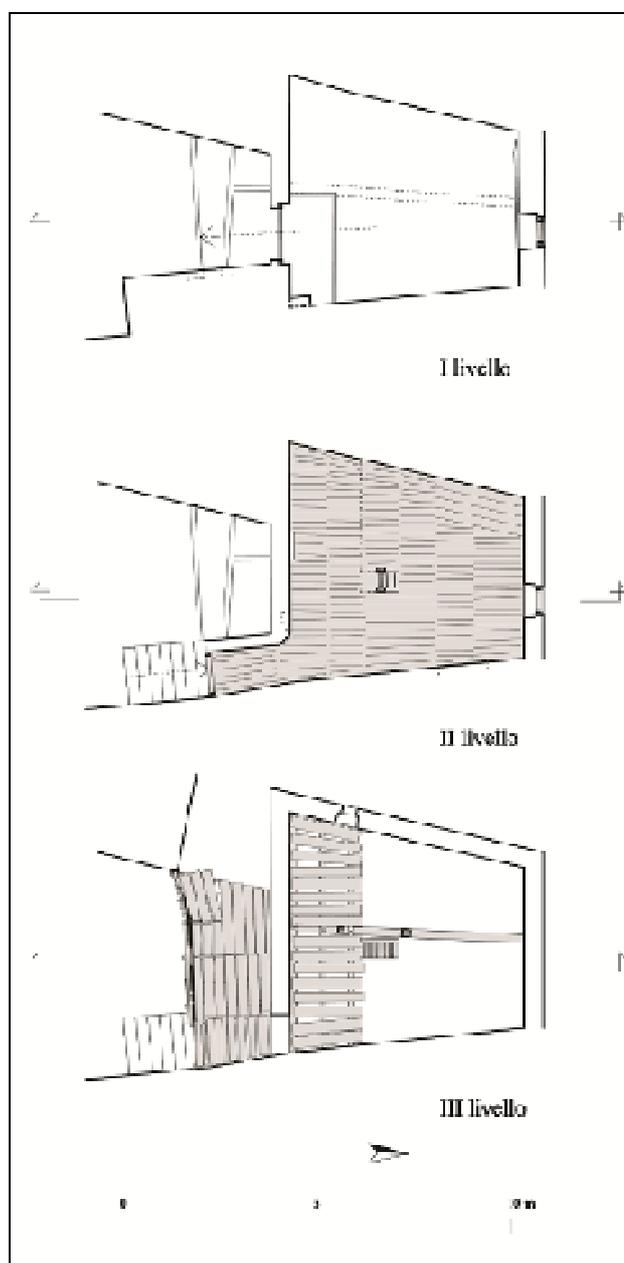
Sante Marie. Casa con ballatoio Cursi, in via Cesare Battisti. Planimetrie dei tre livelli (rilievo di M. Bianchini)
